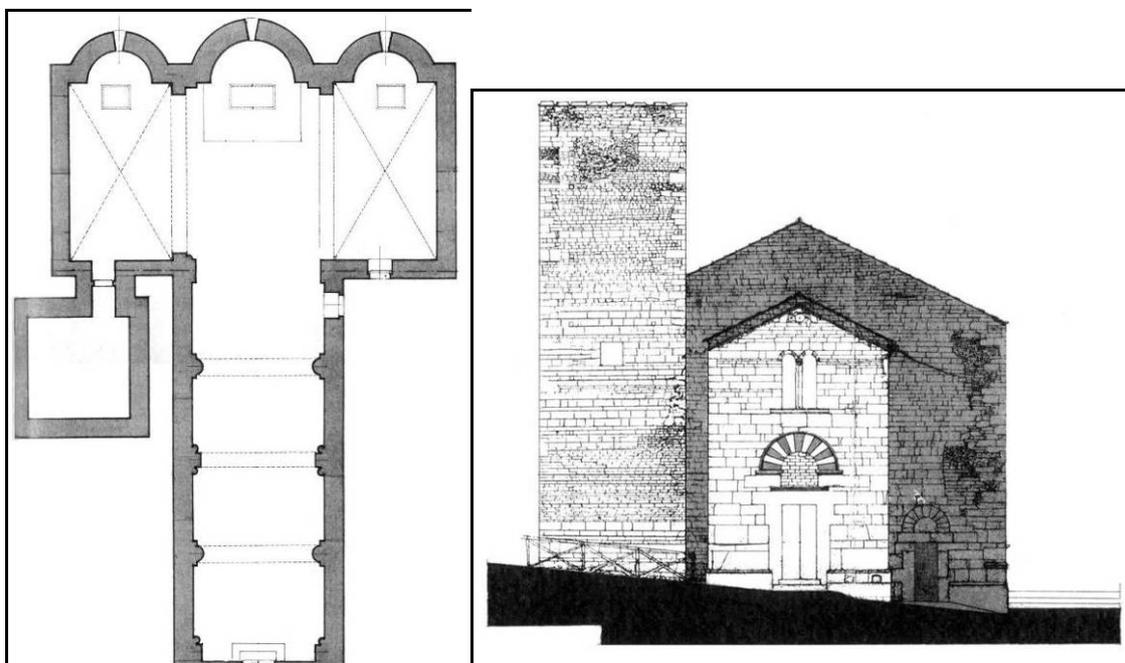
Abbazia di San Giusto al Pinone: pianta e prospetto ovest [da VIOLANTI 1983]
